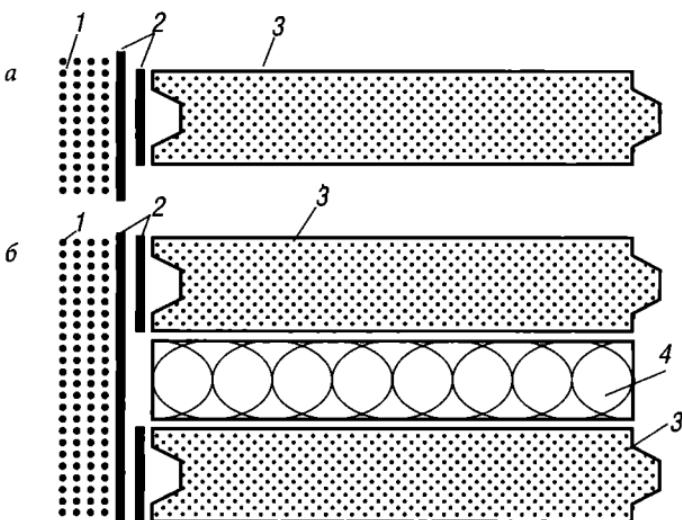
Горизонтальный разрез перегородок из гипсоплит:
